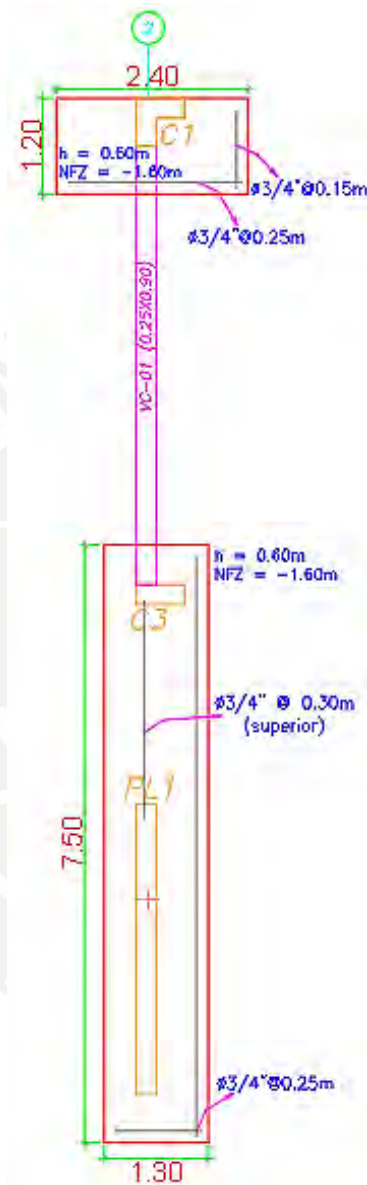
Diseño final de zapata lateral de la columna C1 (eje A-2) conectada a la zapata combinada de la placa PL1 y la columna C3 (eje C-2)
